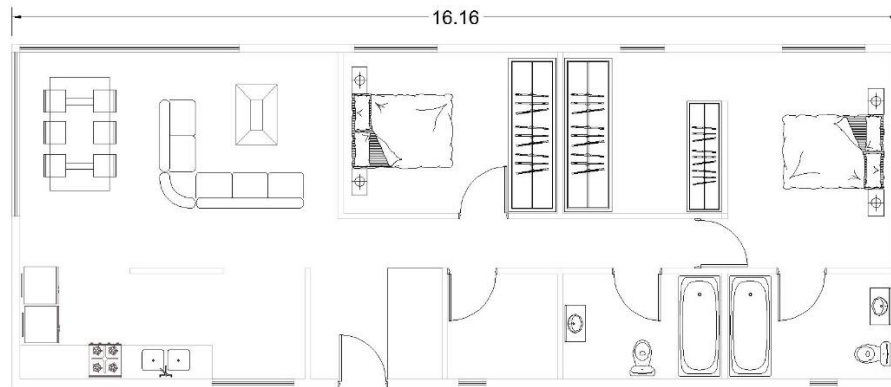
Planta de distribución arquitectónica, con dimensiones generales de 16.16 m. de longitud por 6.10 m de ancho y un total de 98.57 m² de construcción (CASAS CUBE, 2016).
